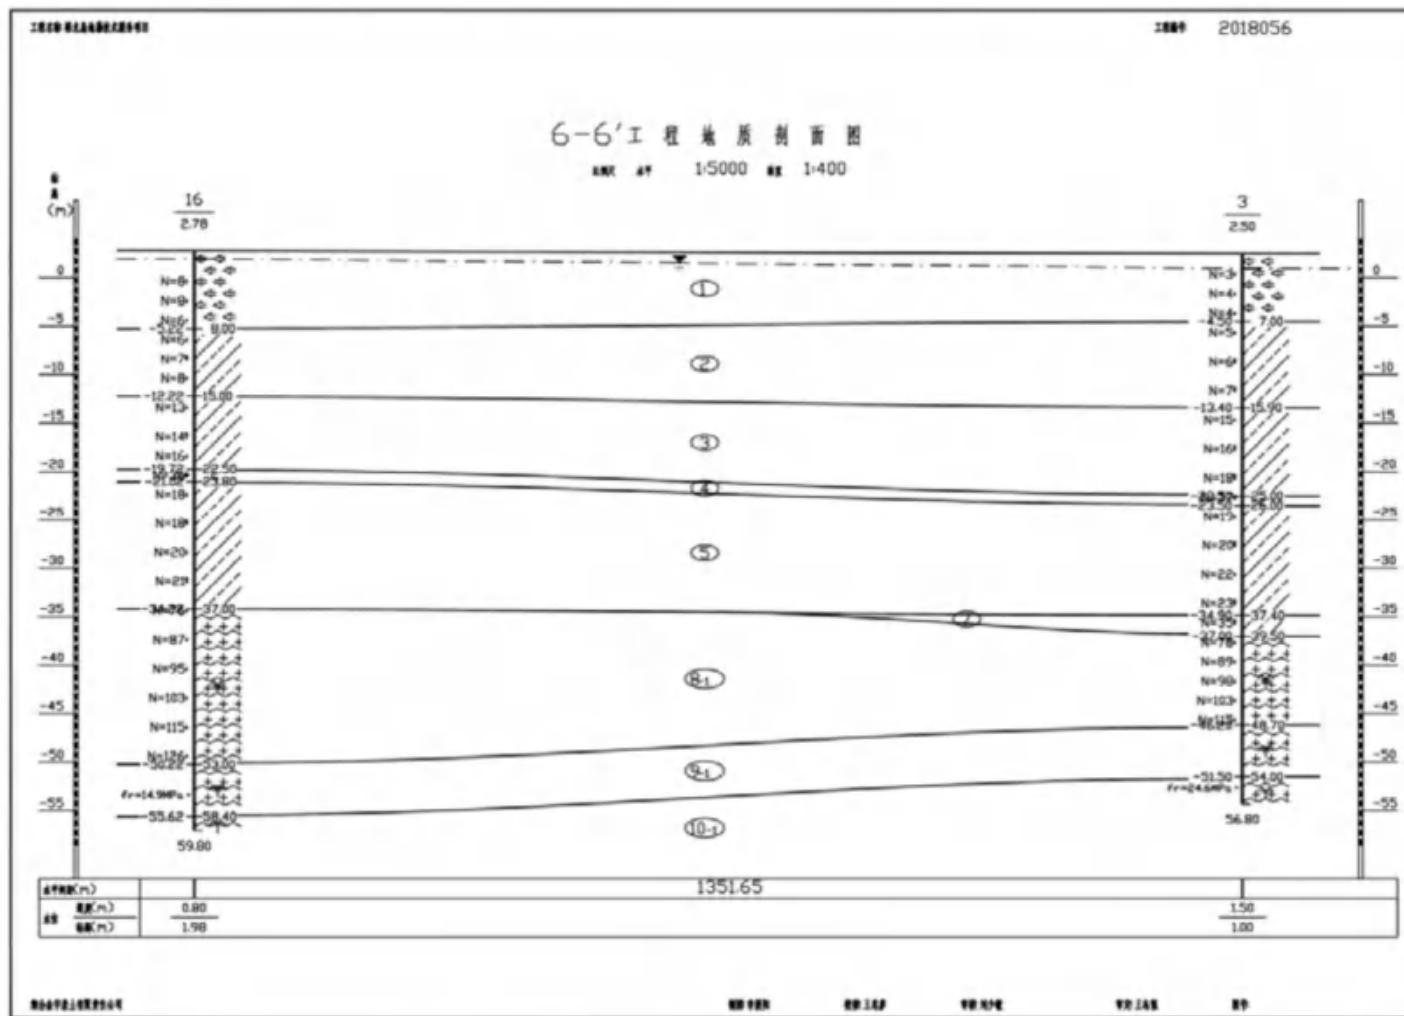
典型工程地质剖面图 (6-6'剖面)
